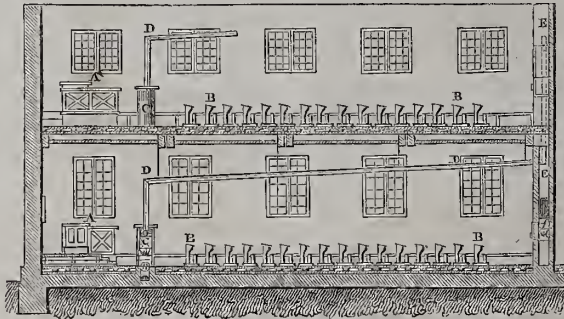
Coupe en long de deux salles d'école, l'une au rez-de-chaussée, l'autre au premier.
